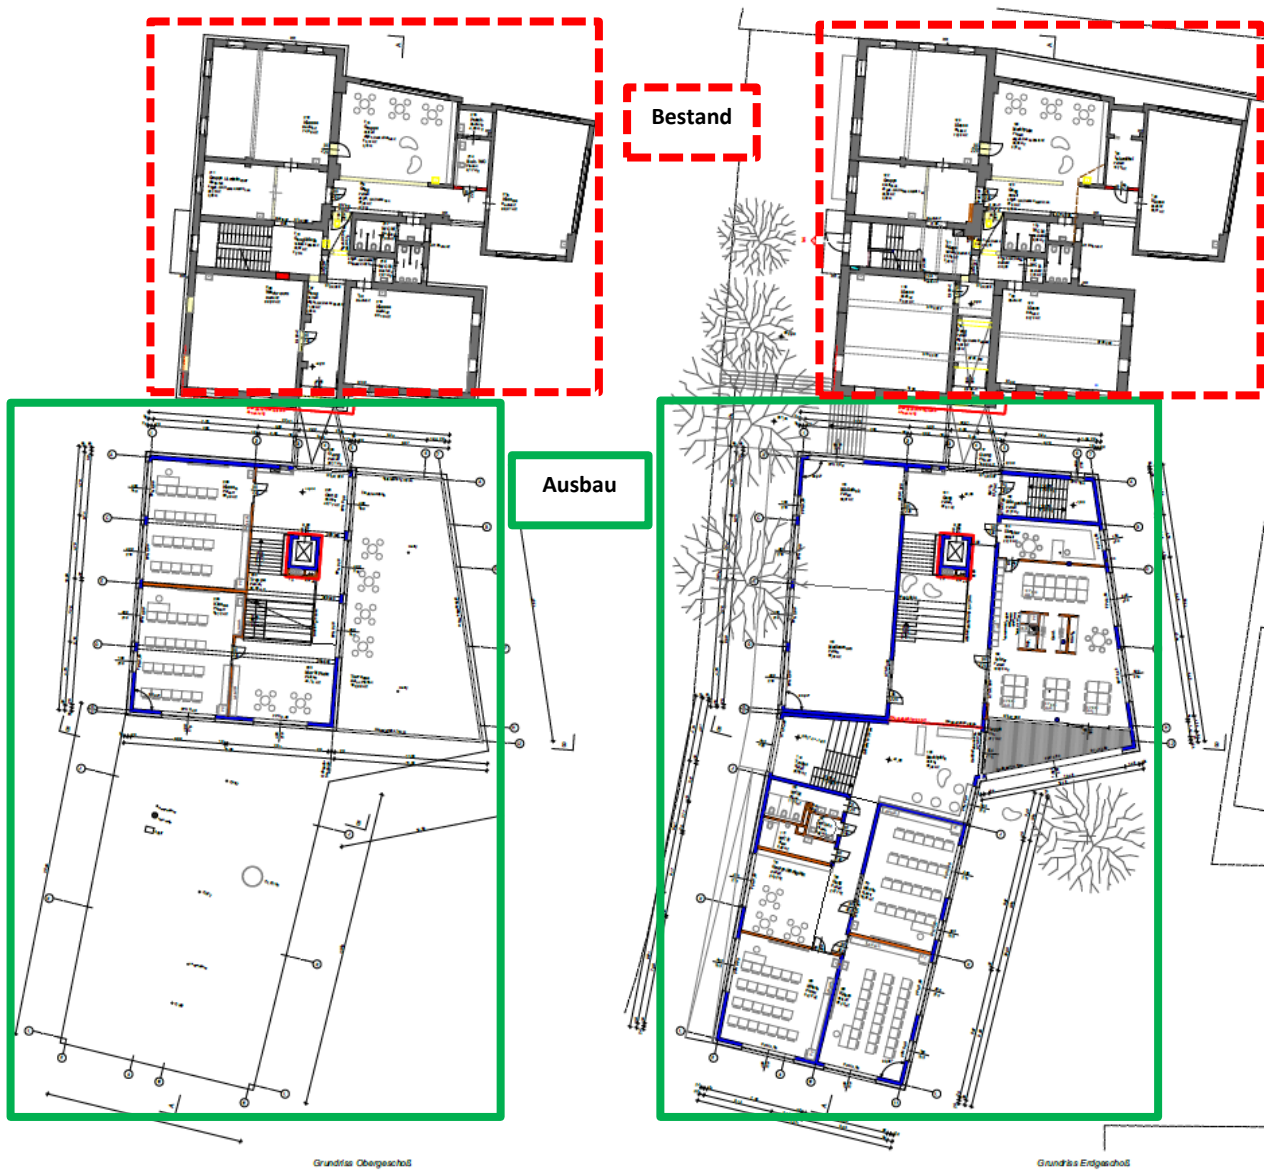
Grundrisse - Ausbau VS Straßgang Obergeschoß und Erdgeschoß
